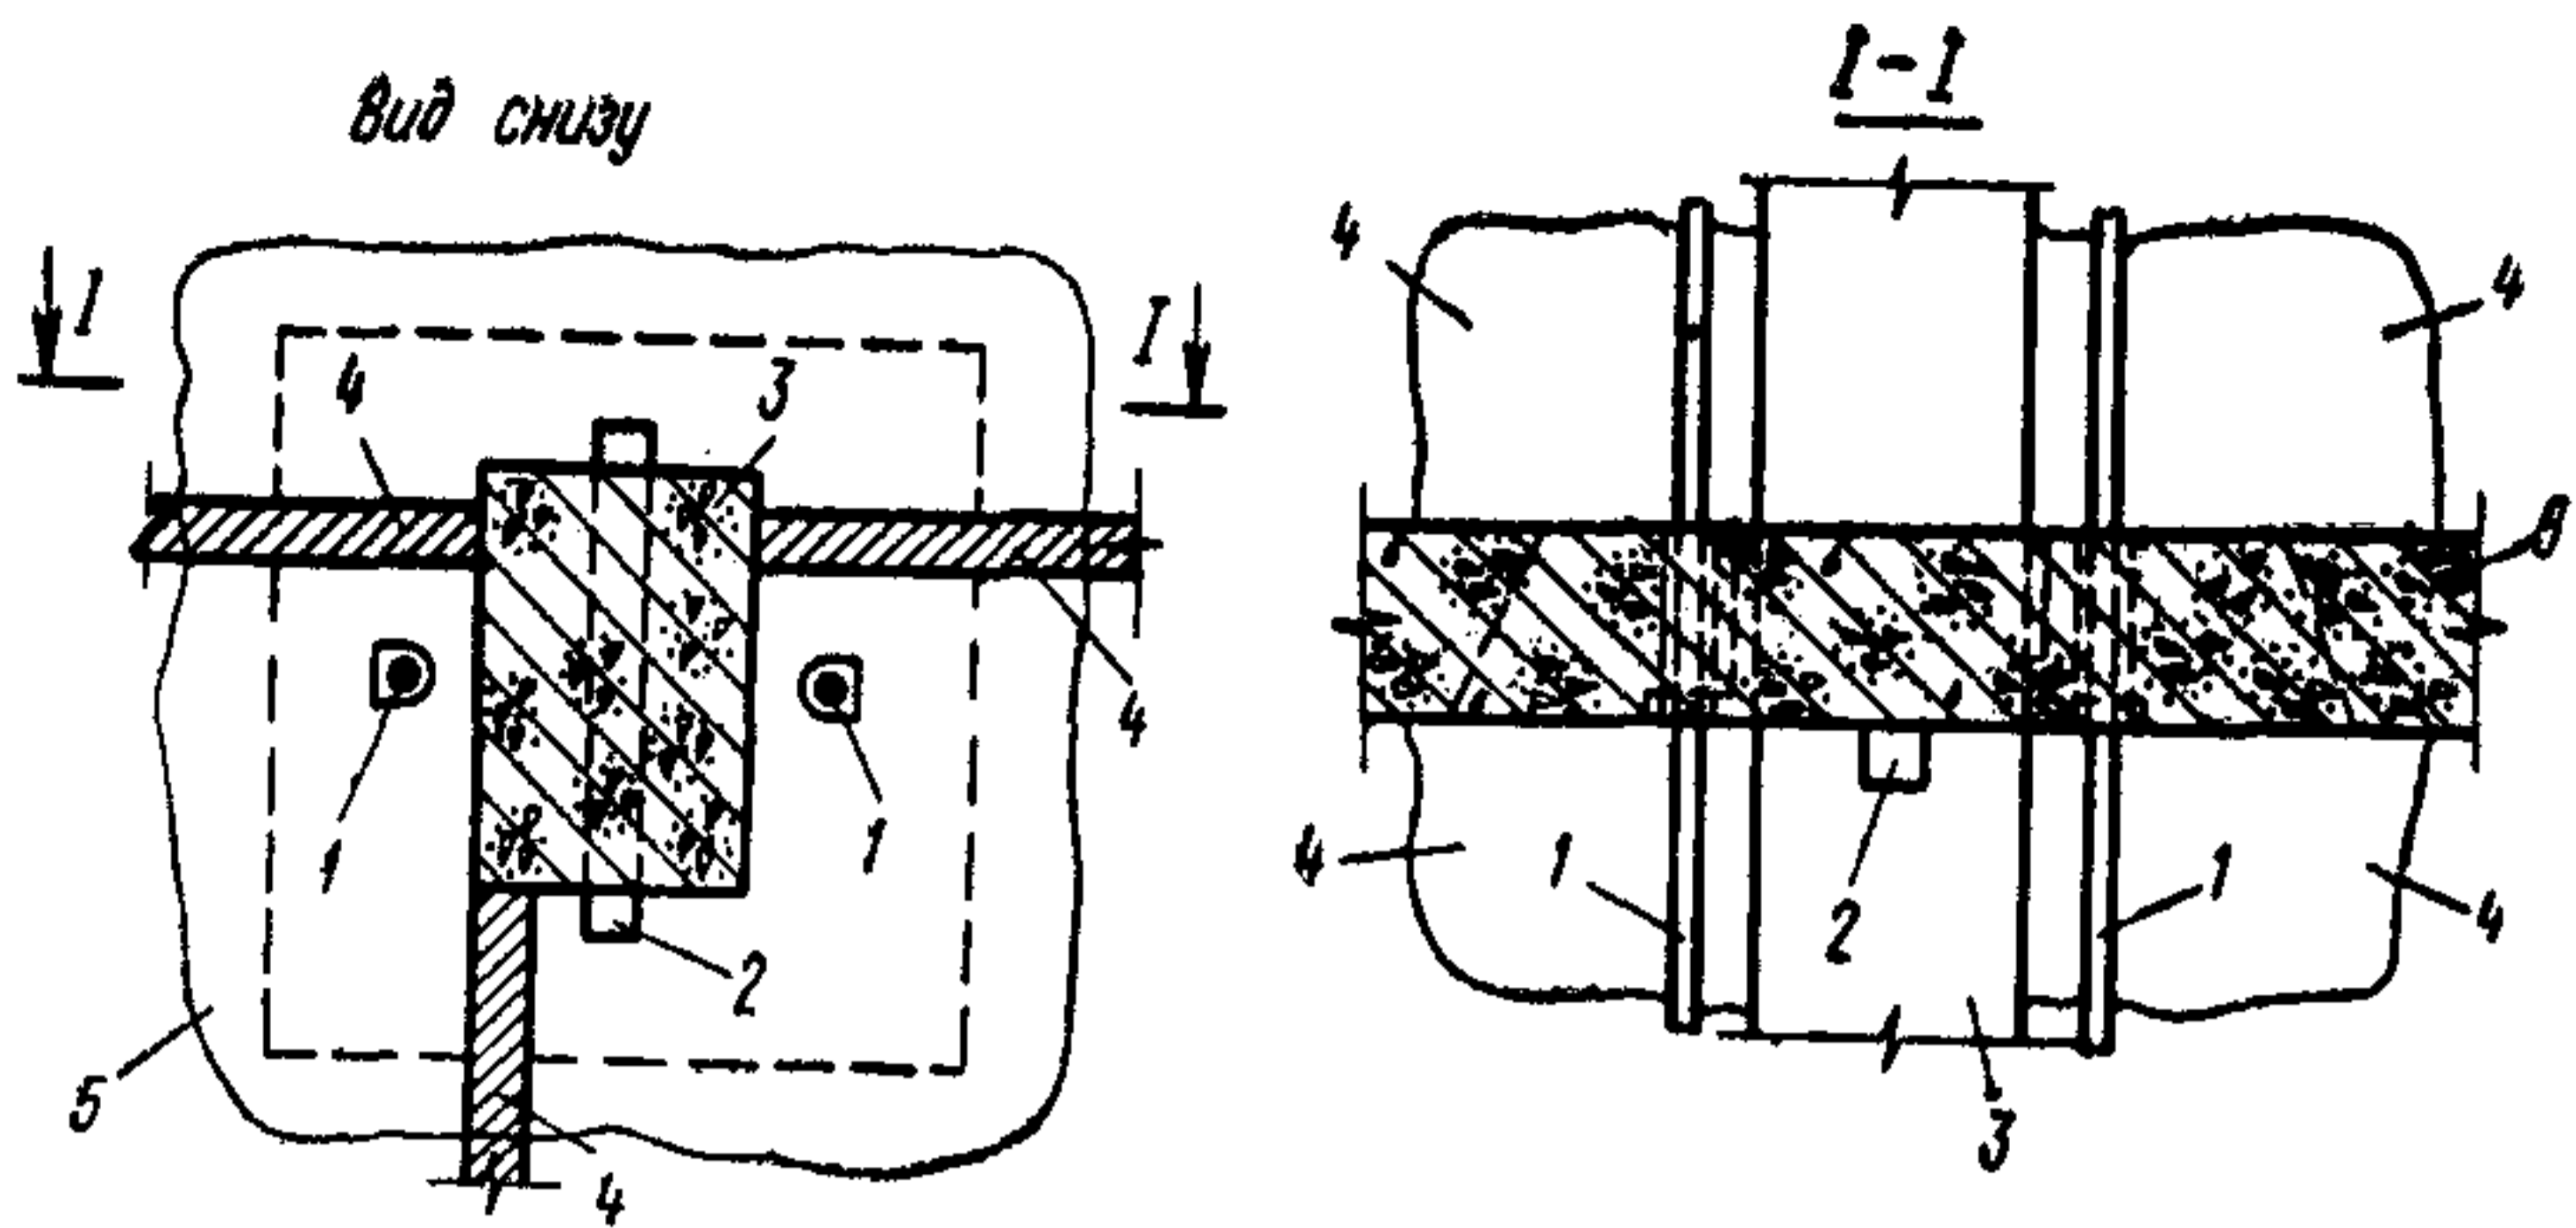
Примыкание перегородок к колонне в зданиях, возводимых методом подъема этажей
